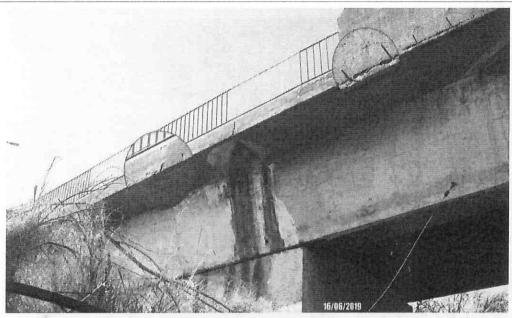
Detalhe de infiltração na viga principal, desplacamento de concreto na face lateral da laje e armadura exposta. Recorrente em toda a extensão do viaduto.
